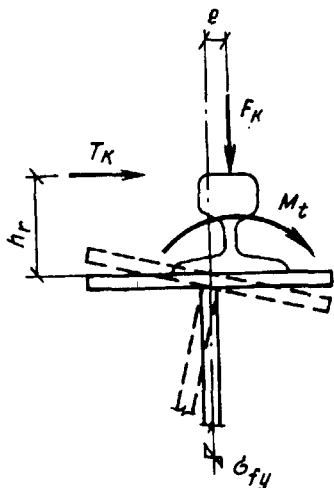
Схема действия вертикальной и горизонтальной сил на подкрановую балку
